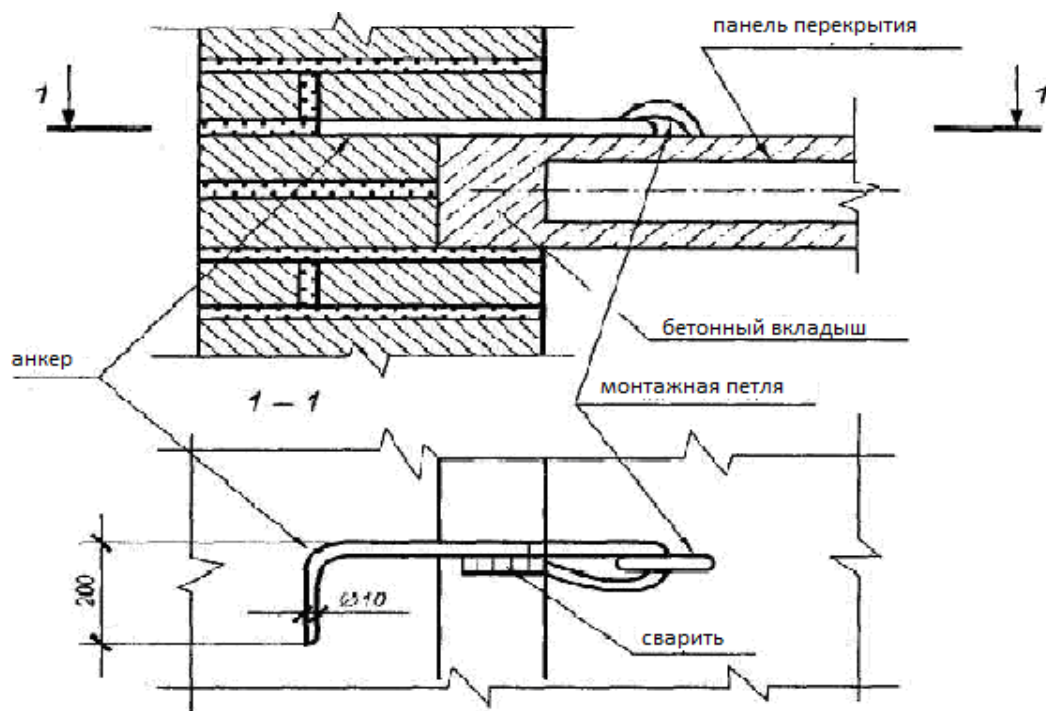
Крепление панели перекрытия в кирпичной стене
